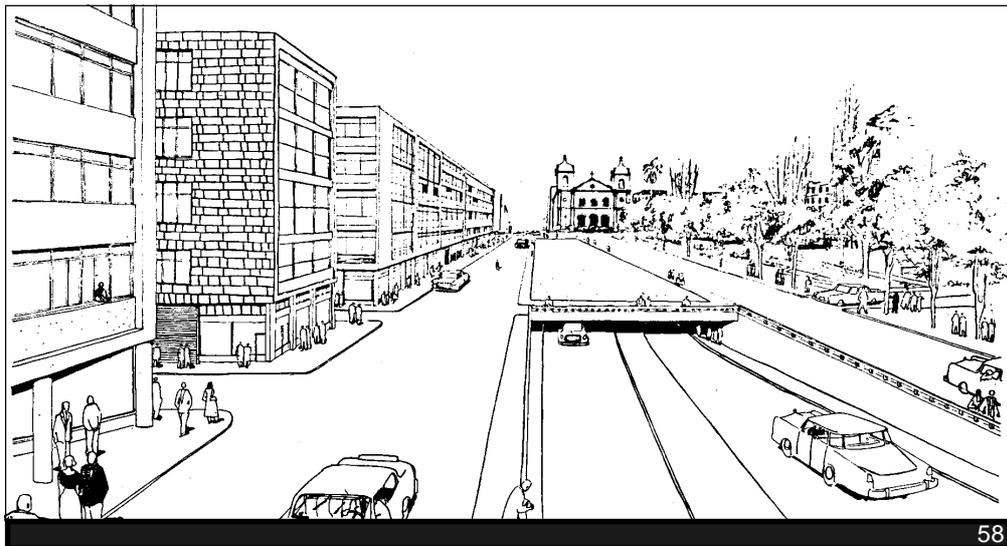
Croqui da Avenida Perimetral - Trecho "c". Fonte: Plano Diretor 1954/64 - Porto Alegre.
